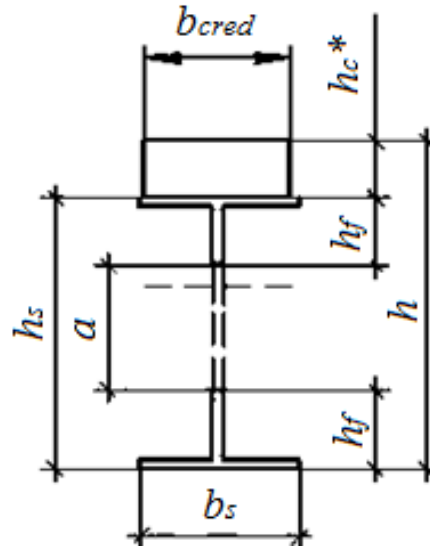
Перетин з еквівалентної складової, що відображає залізобетонну плиту
